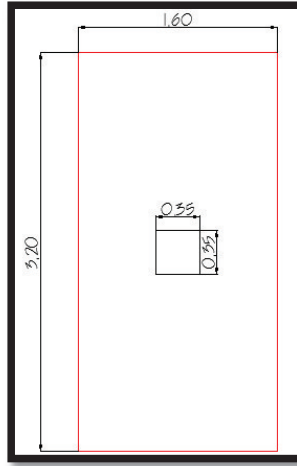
Dimensiones apropiadas propuestas para el plinto de cimentación.
